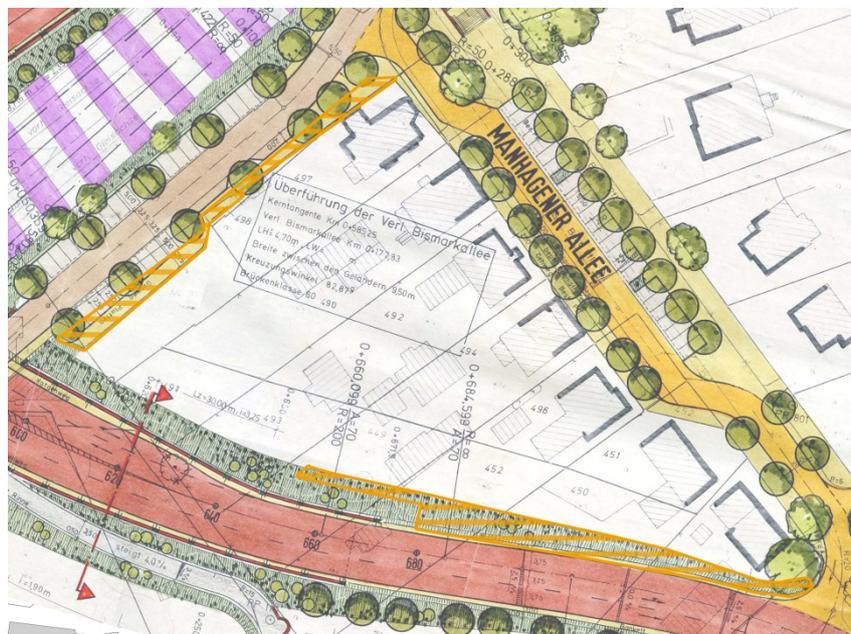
Abweichungen vom Planfeststellungsbeschluss (orange)
